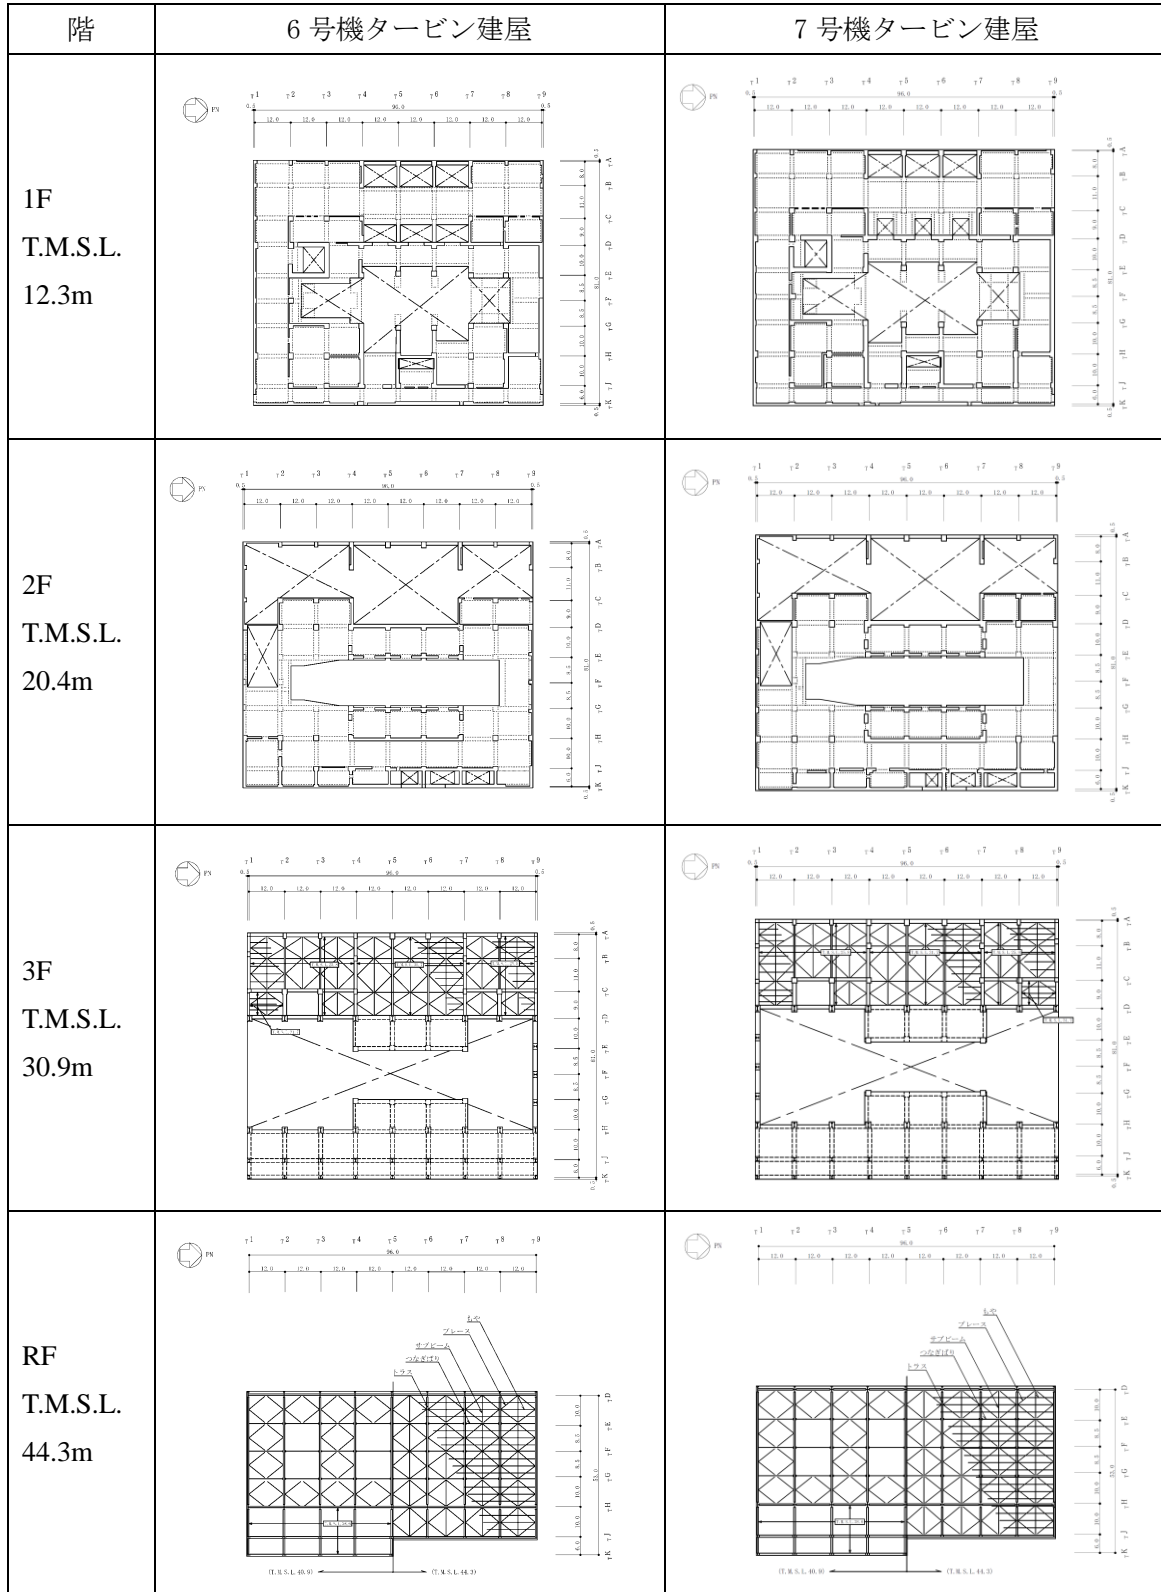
6号機タービン建屋及び7号機タービン建屋の概略断面図 (1/2) (単位:m)
